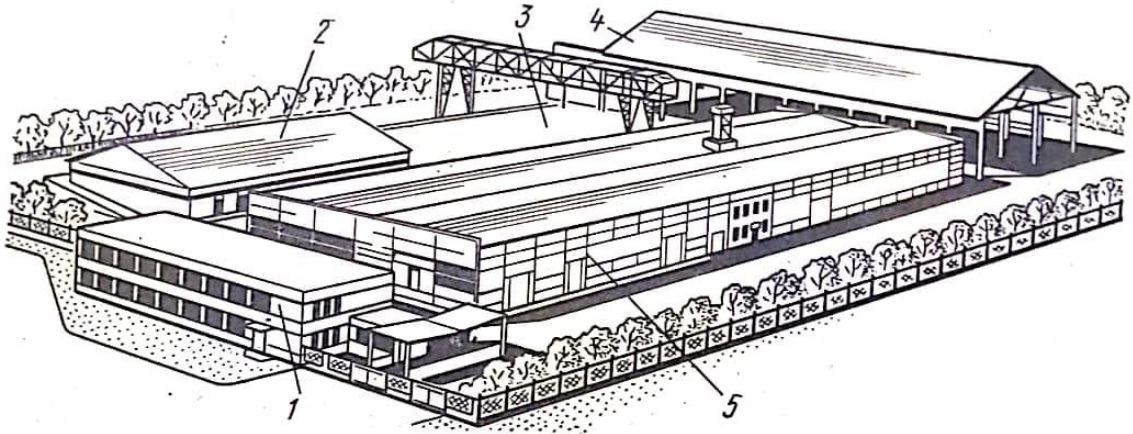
Схема генерального плану УПТК для будівельного тресту.
